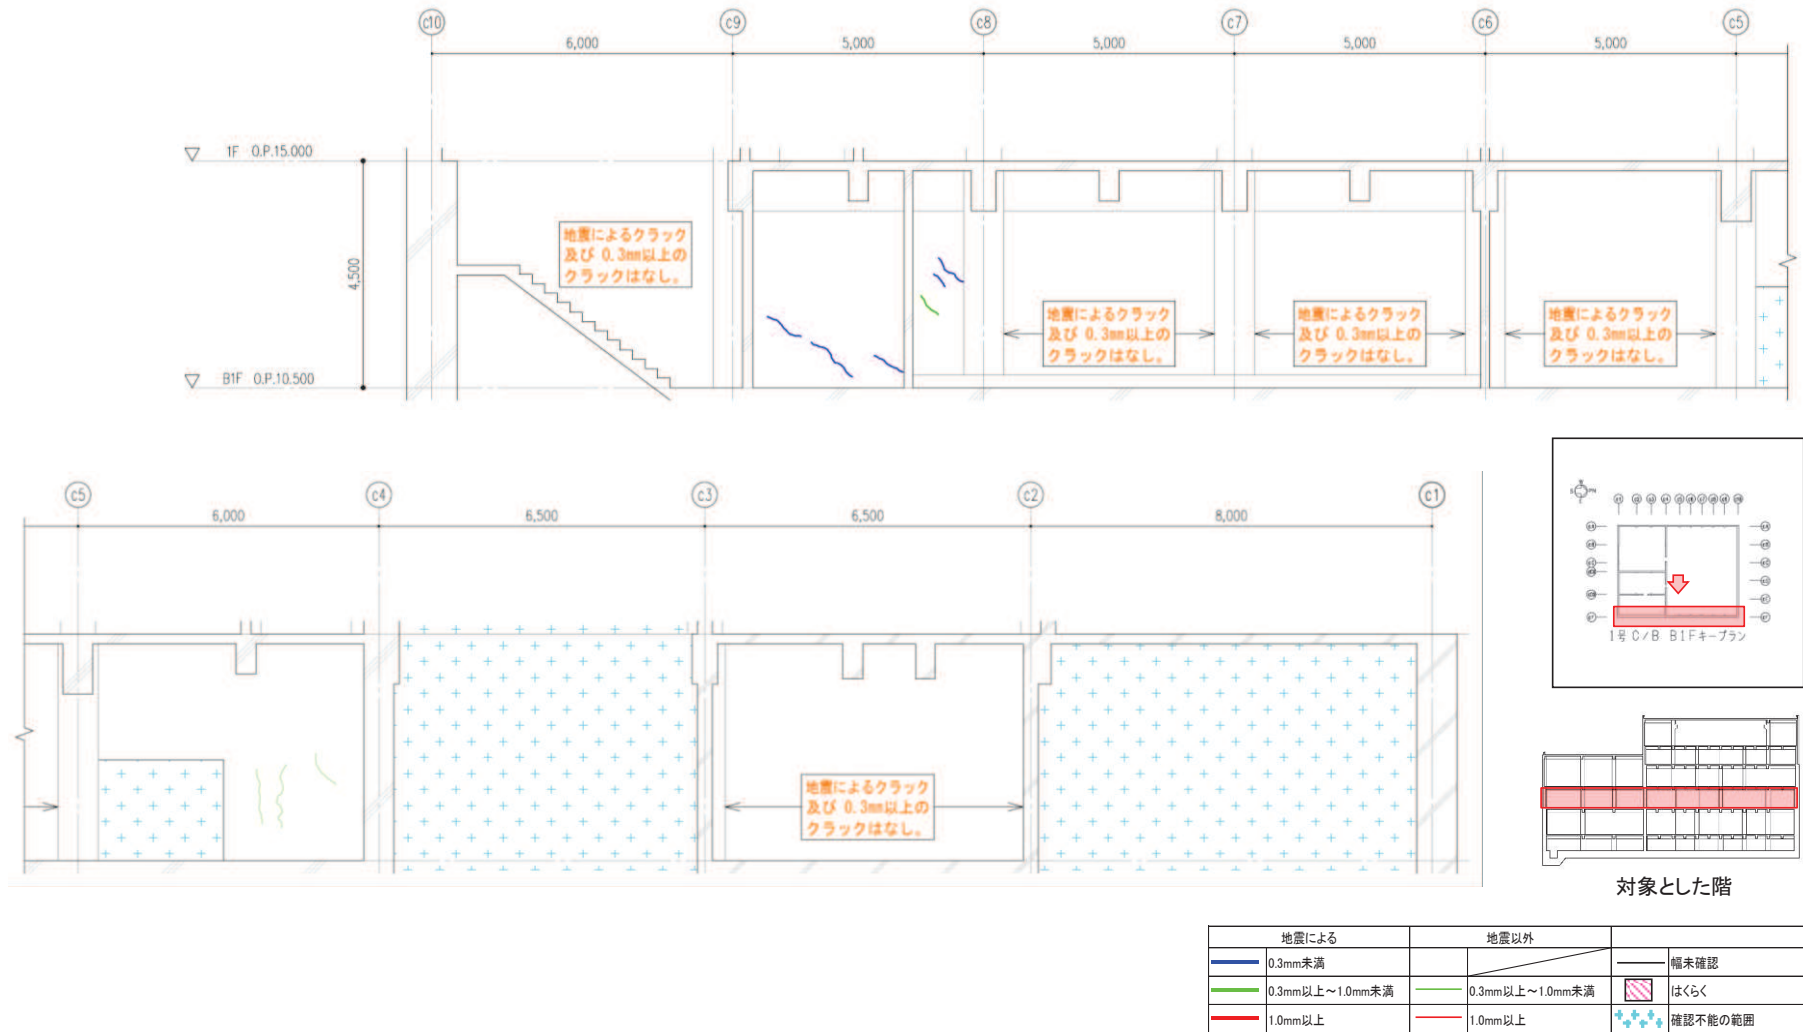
第 1 号機制御建屋のひび割れ分布 耐震壁 (20) 地下 1 階 CF 通り
